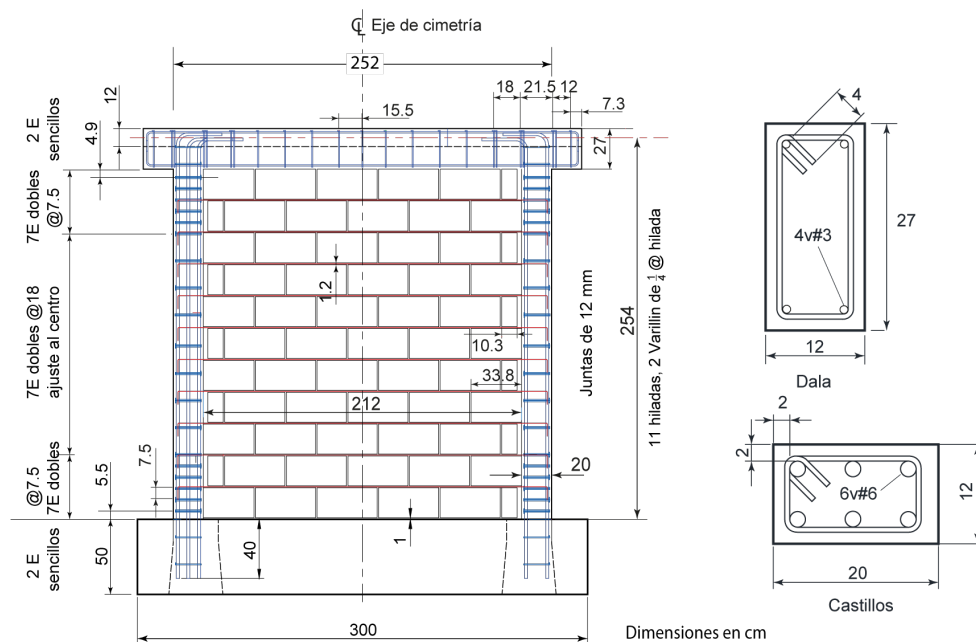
Geometría, refuerzo transversal y longitudinal en castillos, muro MH8R4
